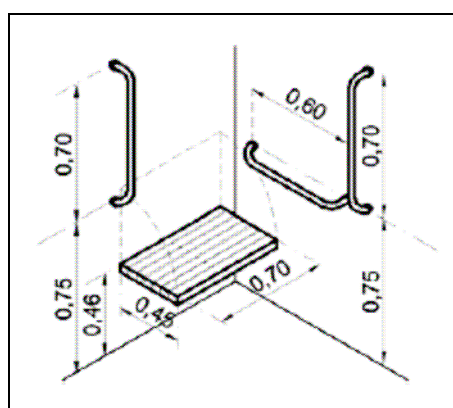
Boxe para chuveiro com barras de apoio vertical e horizontal - Perspectiva (Figura 130 a) da NBR 9050).
